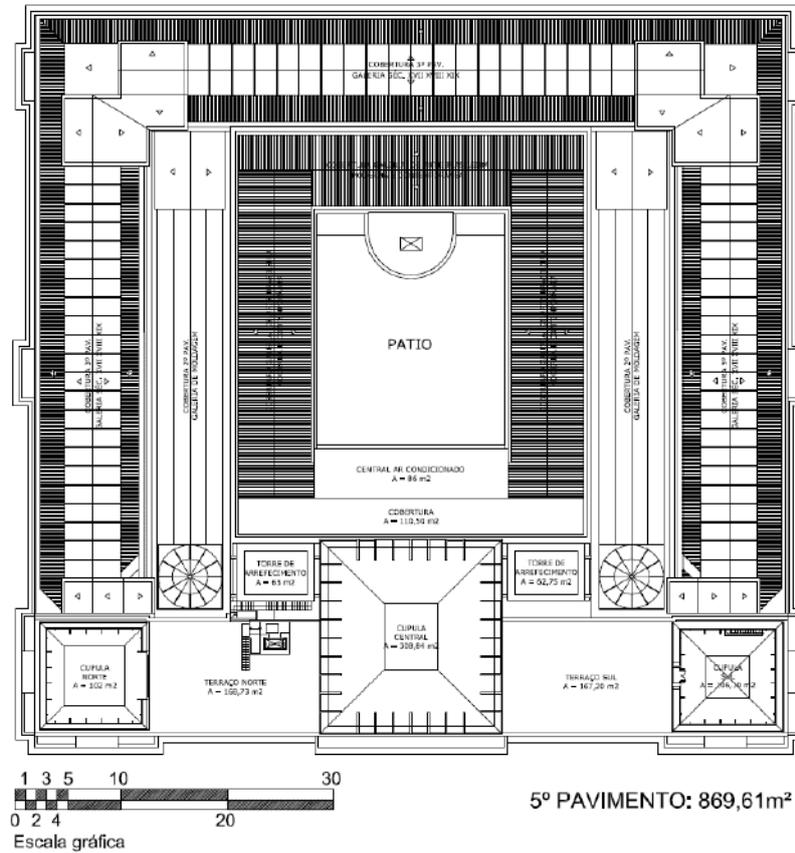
Planta baixa 5º pavimento (cobertura) do MNBA
